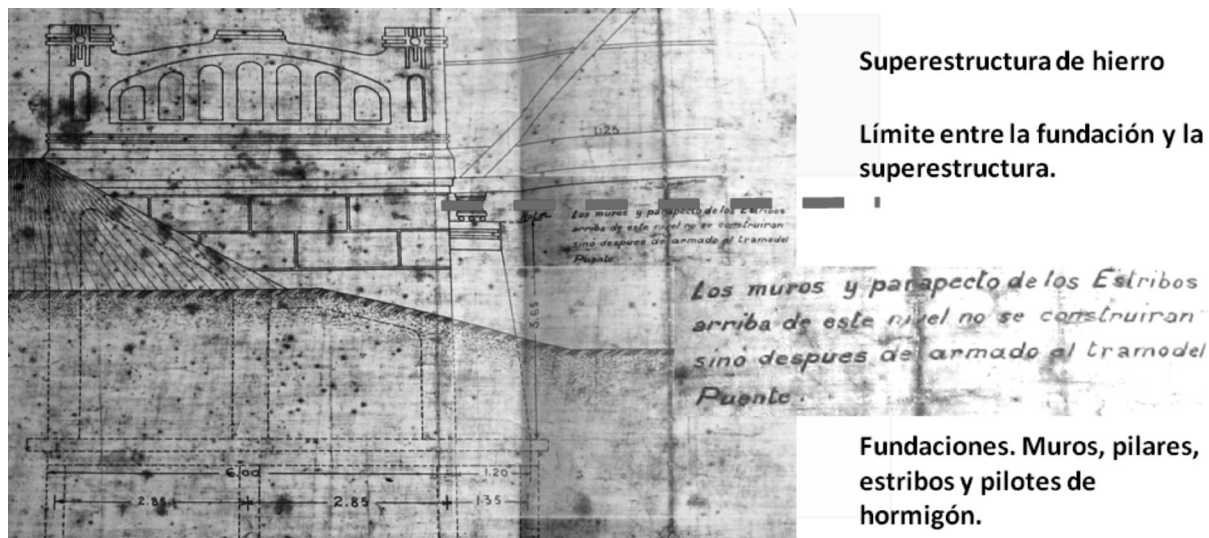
Planos de obra. Sección Transversal. Fuente: Dirección de Hidráulica Sección Dolores.
